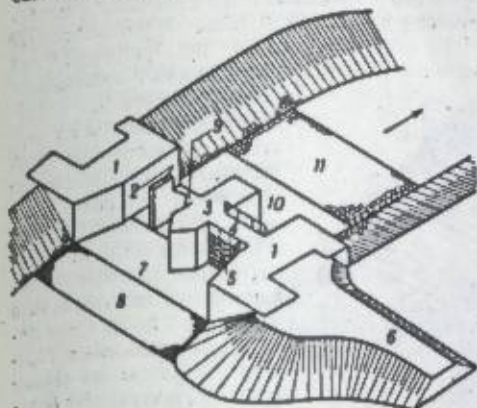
Схематический вид деревянной плотины: 1 — устои; 2 — контрфорсы; 3 — бык; 4 — мост; 5 — щиты; 6 — сопрягающая земляная дамба; 7 — понурный пол; 8 — глиняная подушка; 9 — водобойный пол; 10 — сливной пол; 11 — рисберма.
